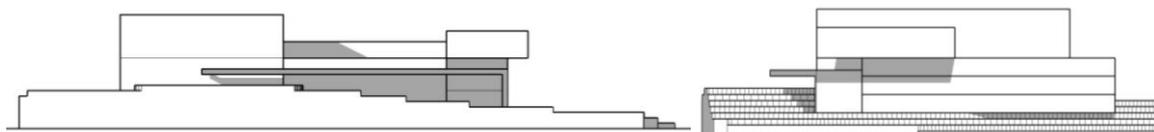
e 169: Estudo volumetrico de fachada norte e oeste.
